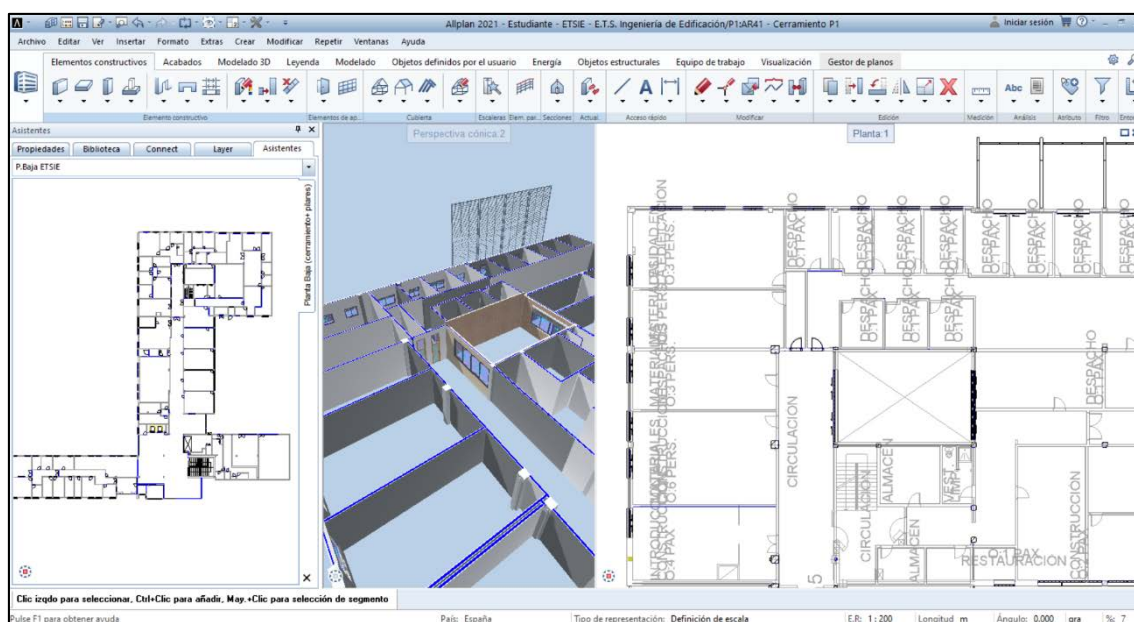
Modelado de tabiquería y carpintería sobre planimetría aportada y con ayuda del asistente. ALLPLAN
